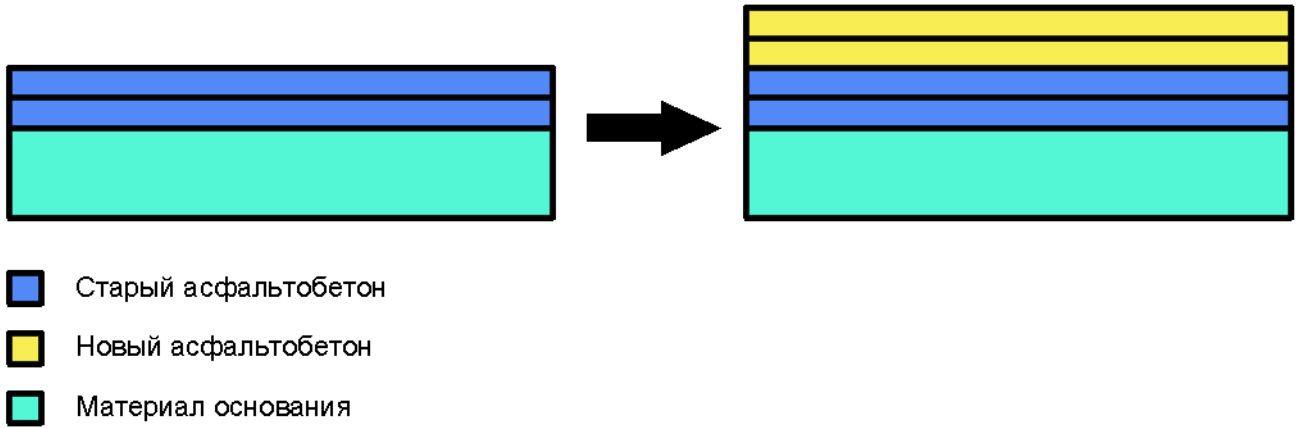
Схема проведения капитального ремонта дорожного асфальтобетонного покрытия без его удаления
